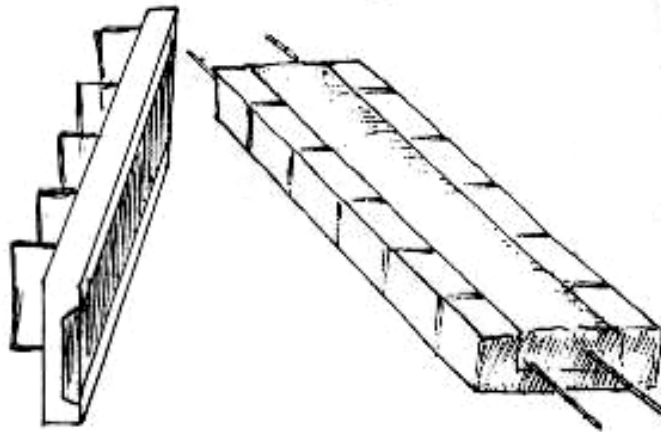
Detalle de estribo y acero de refuerzo en los dinteles.
